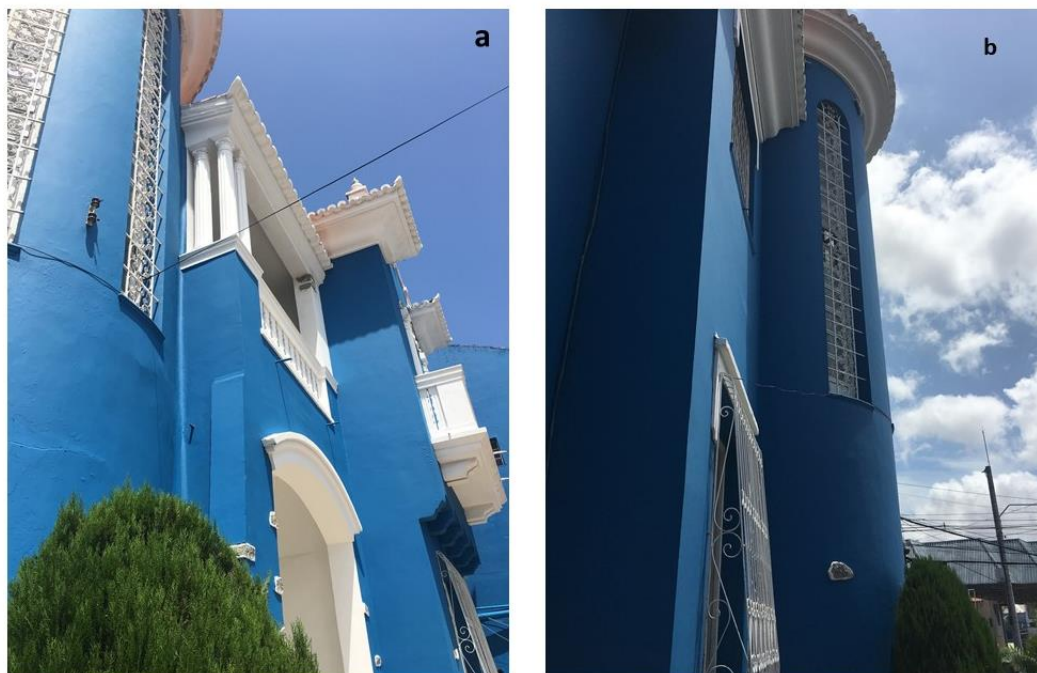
Detalhes elementos da fachada: colunas toscanas, cachorros do balcões sacados (a) e do torreão (b).
